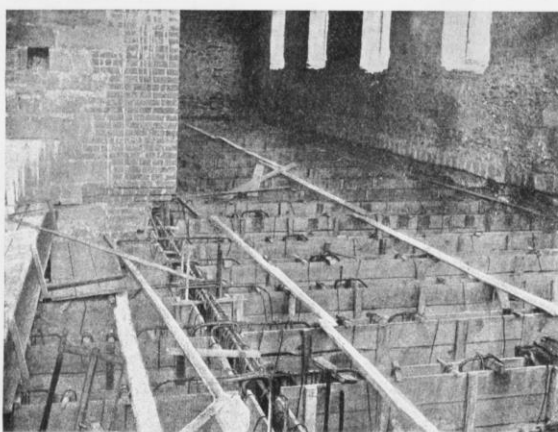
Подвалъ Станціи. Снимокъ изображаетъ бродильныя отдѣленія (до устройства раздѣляющихъ ихъ перегородокъ) съ цѣлью демонстрировать устройство желѣзо-бетоннаго перекрытія надъ погребомъ для хранения винъ. На нижнемъ желѣзо-бетонномъ перекрытіи подвала (перекрытіе двойное съ желѣзо-бетонными-же балками между перекрытіями) установленъ рядъ досчатыхъ формъ для желѣзо-бетонныхъ балокъ. Въ формы заложены желѣзные круглаго сѣченія стержни съ соответственнымъ изгибомъ ихъ, мѣстомъ расположенія, діаметромъ сѣченія и способомъ соединенія со стержнями нижняго желѣзо-бетоннаго перекрытія. Отъ кирпичнаго угла къ зрителю расположена форма для основной поперечной желѣзо-бетонной балки, несущей нагрузку отъ ряда балокъ и покоящейся на двухъ желѣзо-бетонныхъ колоннахъ въ погребѣ.
